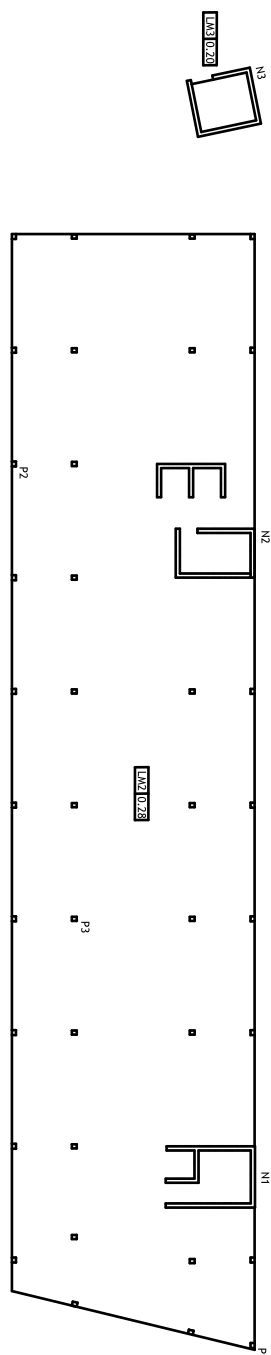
Edifício real: planta estrutural do piso 7
